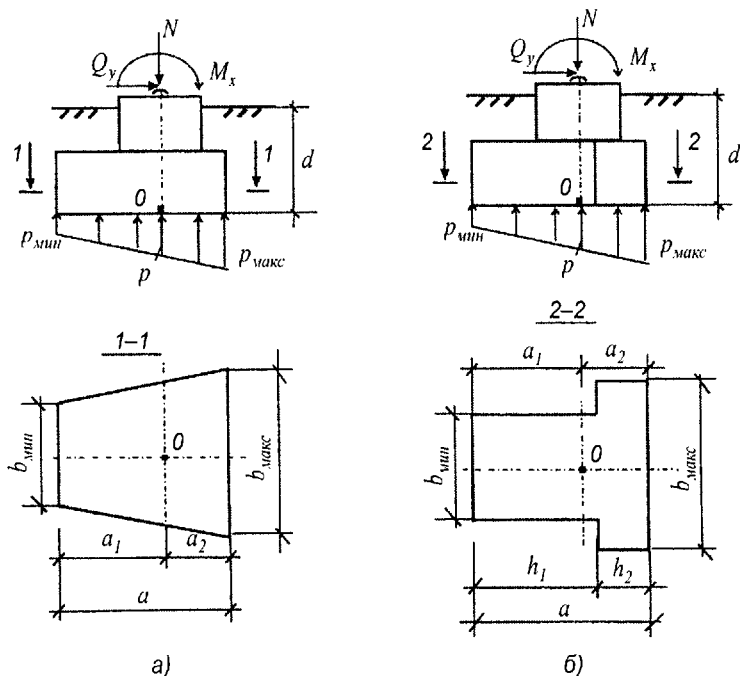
Схемы к определению размеров подошвы внецентренно нагруженных фундаментов: а – с трапецевидной формой подошвы в плане; б – с тавровой формой подошвы в плане
